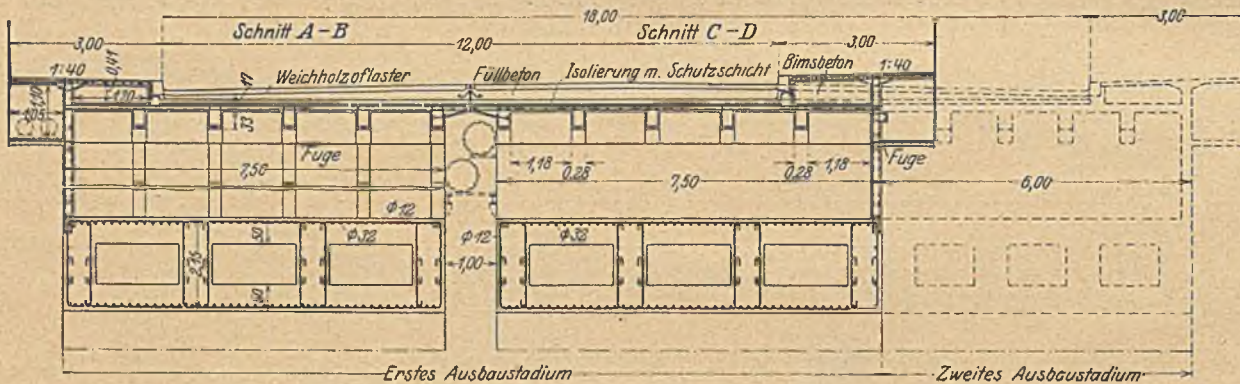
Entwurf Jager G. m. b. H., Querschnitt der Hauptöffnung.
